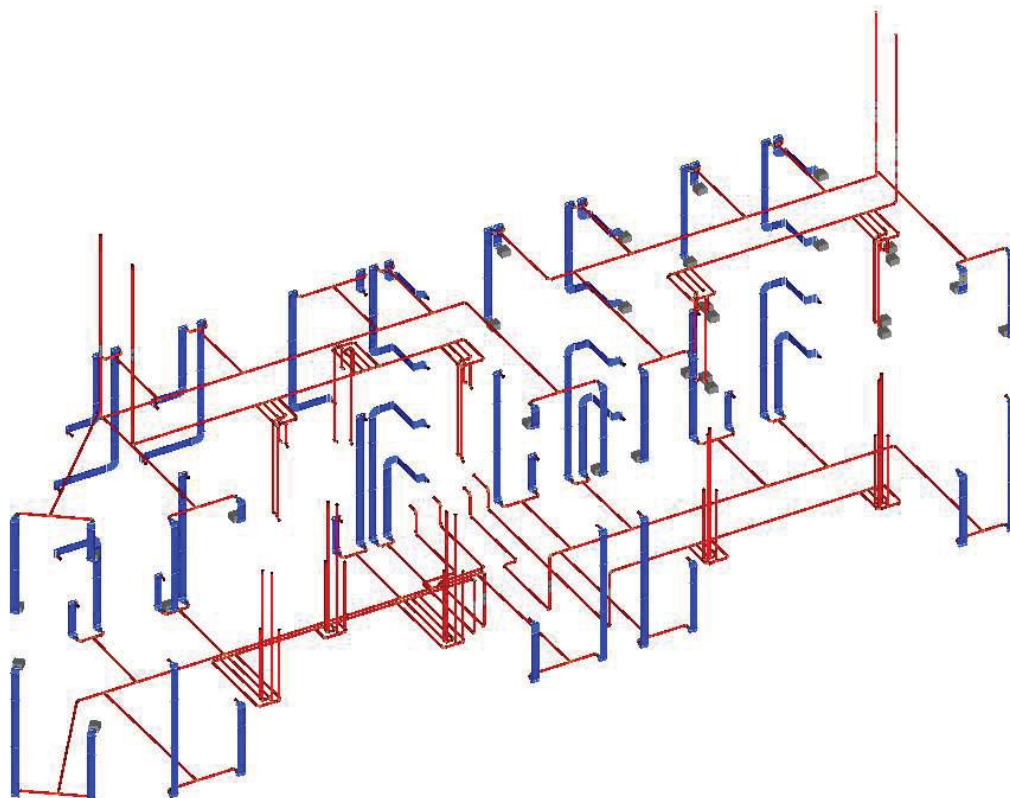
Zu- und Abluftkanalnetz des zentralen Lüftungssystems mit vier Lüftungsanlagen im Keller und auf dem Dachboden, fassadenintegrierte Flachkanäle in Blau, kreisrunde Lüftungsrohre in Rot
